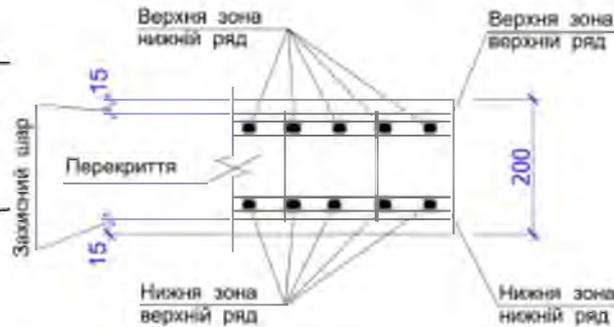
Схема армування типової плити перекрыття секції Б-2
